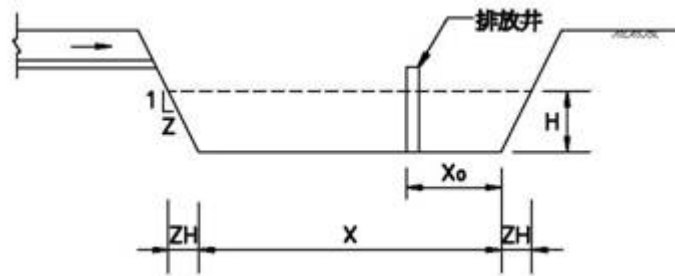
施工中滯洪沉砂池剖面圖(重力式)
